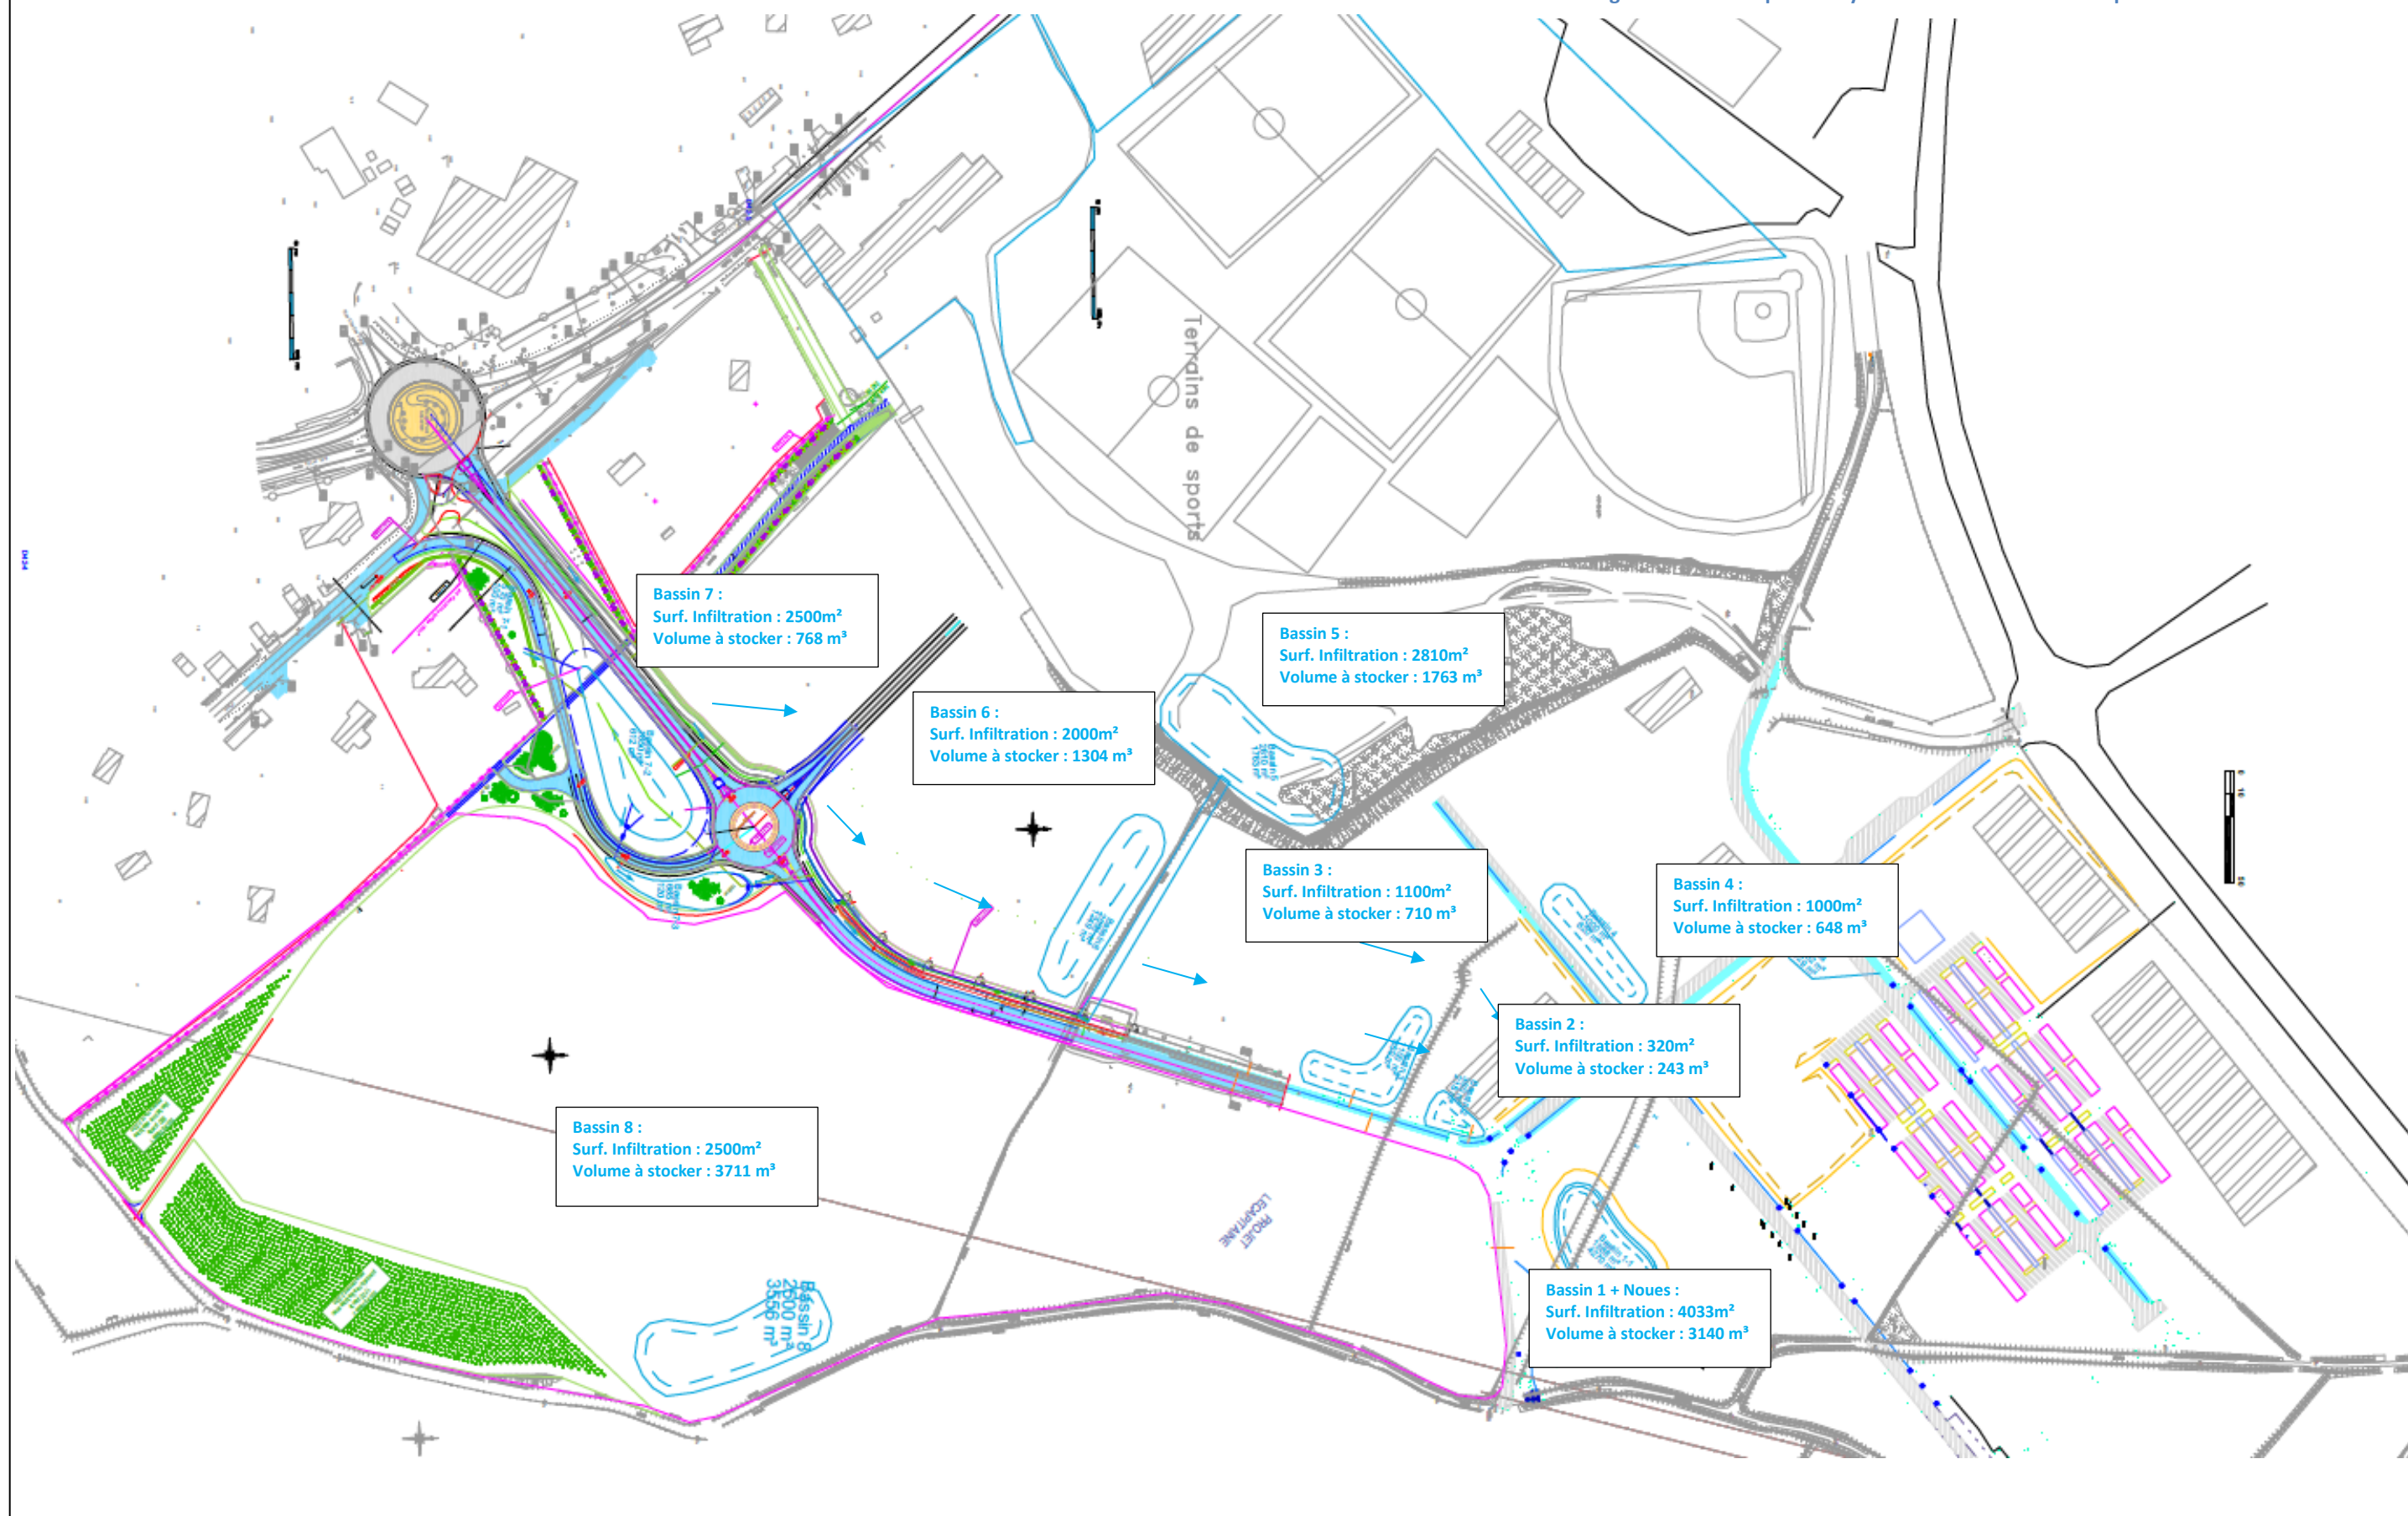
Vue en plan du système de collecte des eaux pluviales
